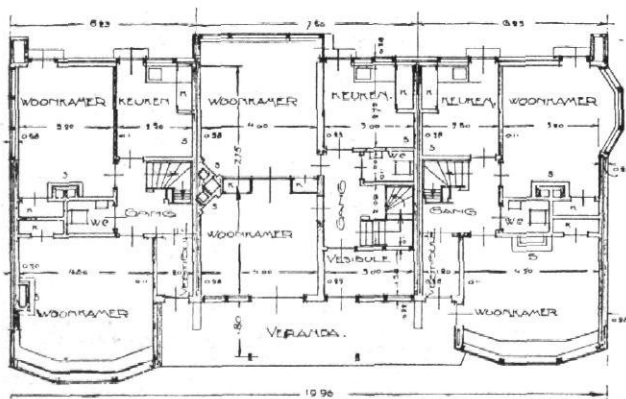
und 3 / Erdgeschloß- und Obergeshloß-Grundrisse zu Abb. 1 / Maßstab 1:250
